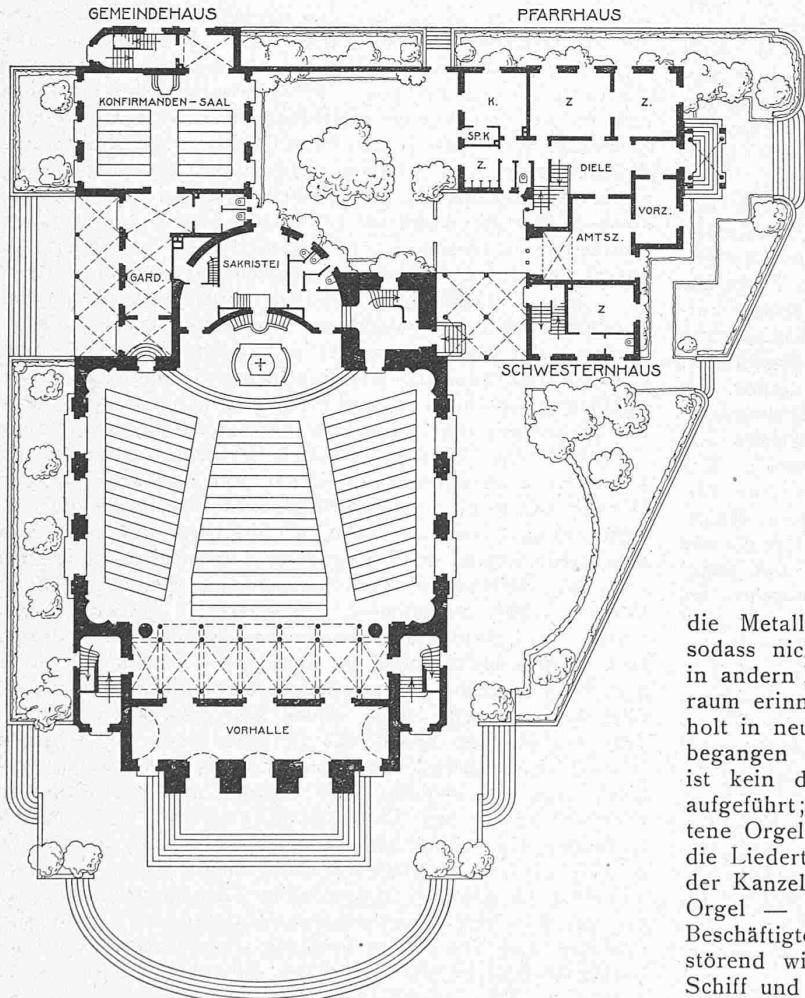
Grundriss der Lutherkirche in Freiburg i. B. — 1:500.
